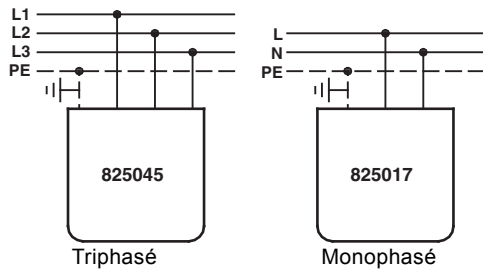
Montage d'un dispositif de protection contre les surtensions
